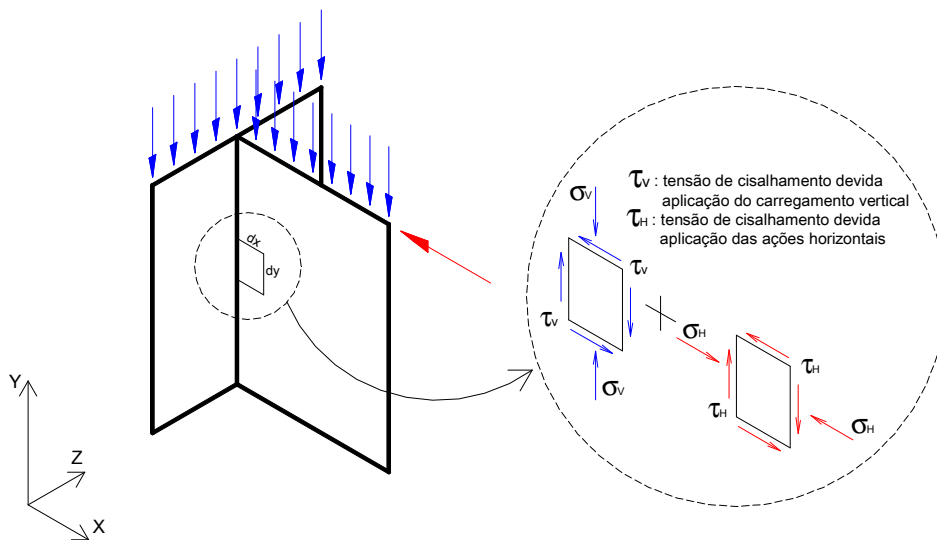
Estado de tensões em um elemento de alvenaria submetido ao cisalhamento considerando as ações verticais e horizontais.
